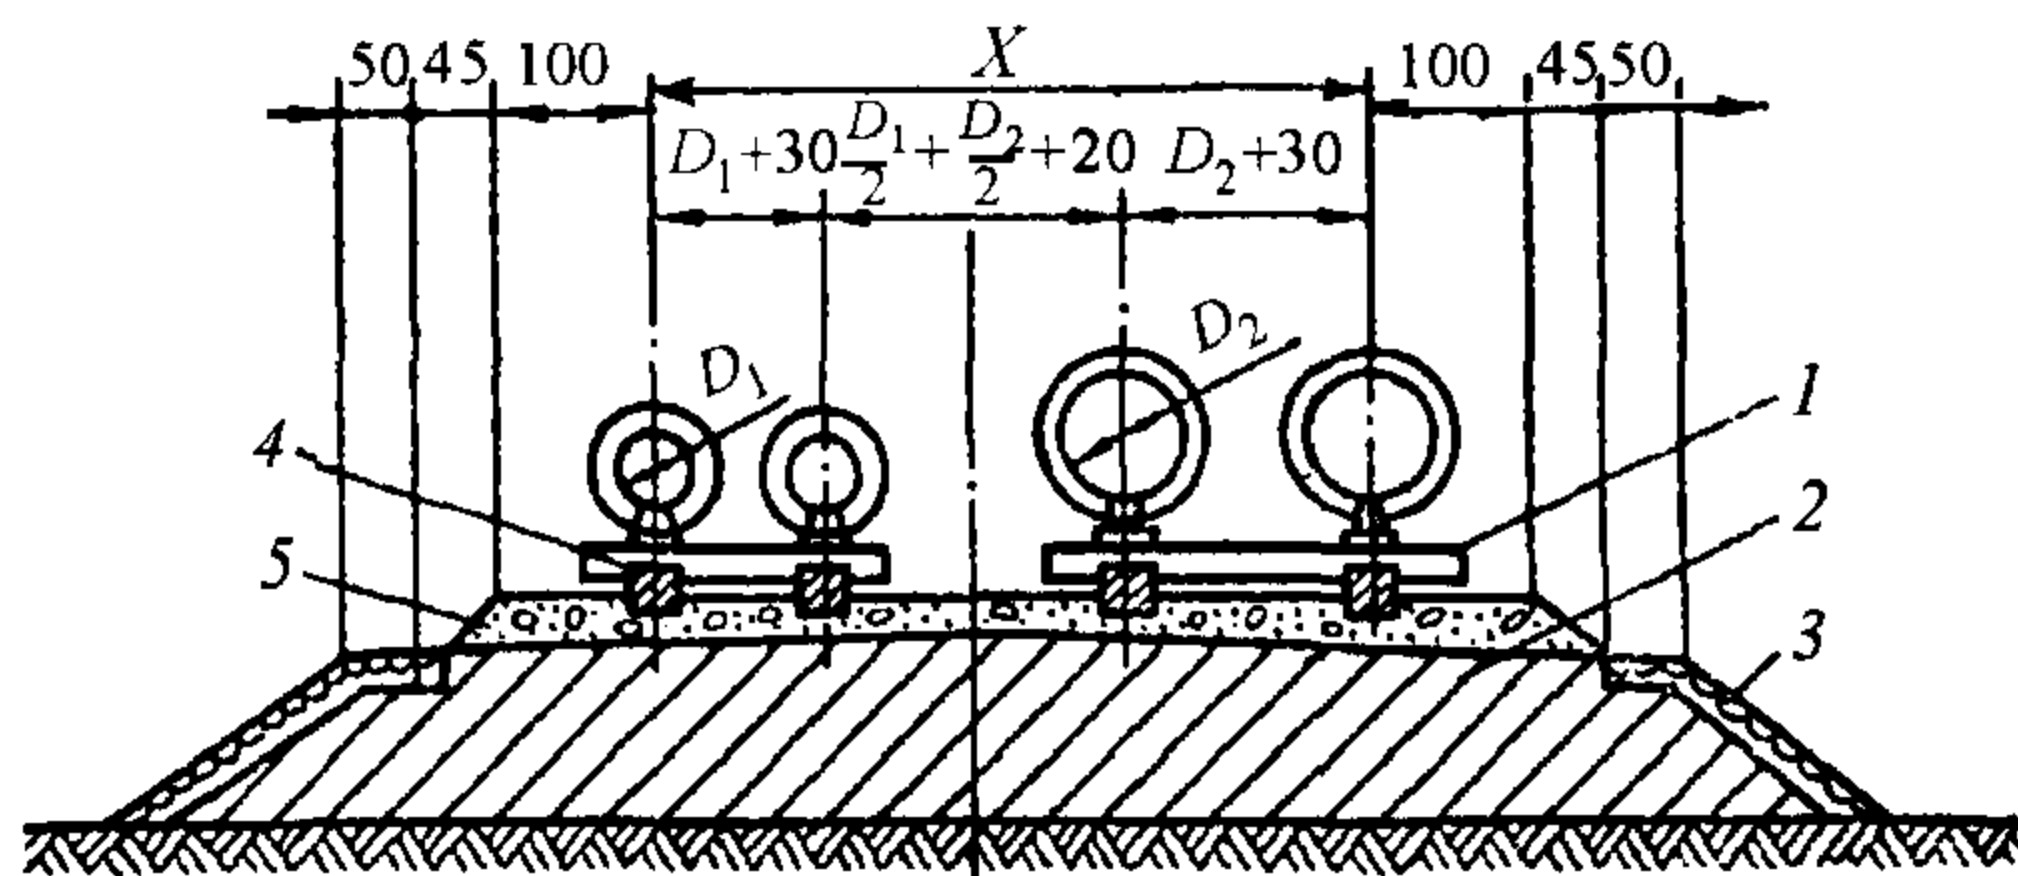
Наземная совмещенная прокладка трубопроводов на лежневых опорах: 1 – опорный брус сечением 20 x 20 см; 2 – грунтовая насыпь; 3 – отстойка на мху; 4 – шпалы (лежни); 5 – балластный слой
